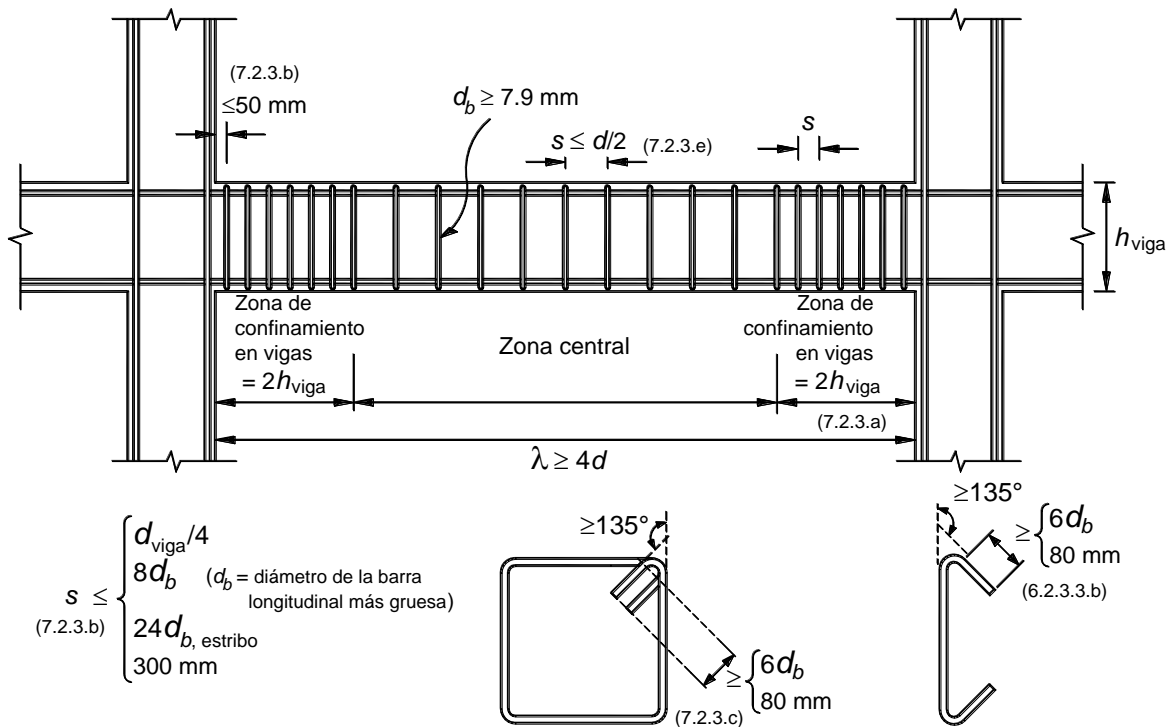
Detallado de elementos a flexión de marcos dúctiles
